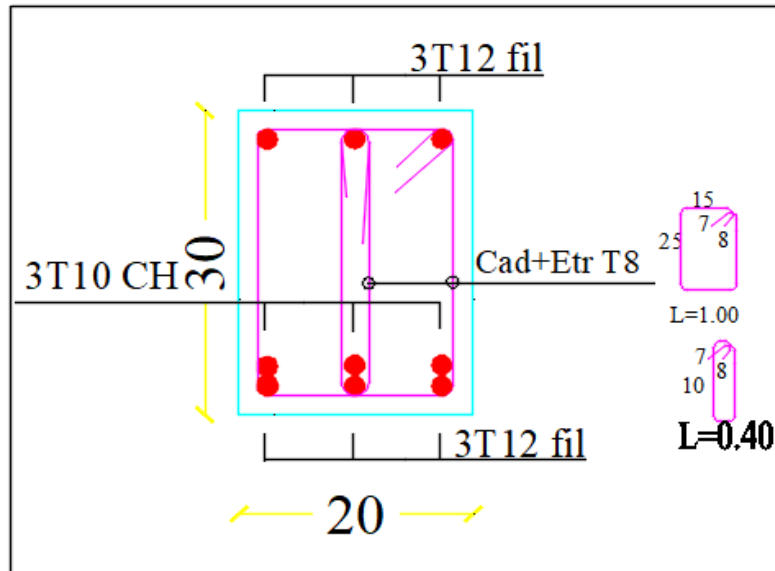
Ferrailage en travée d'une poutre secondaire.
